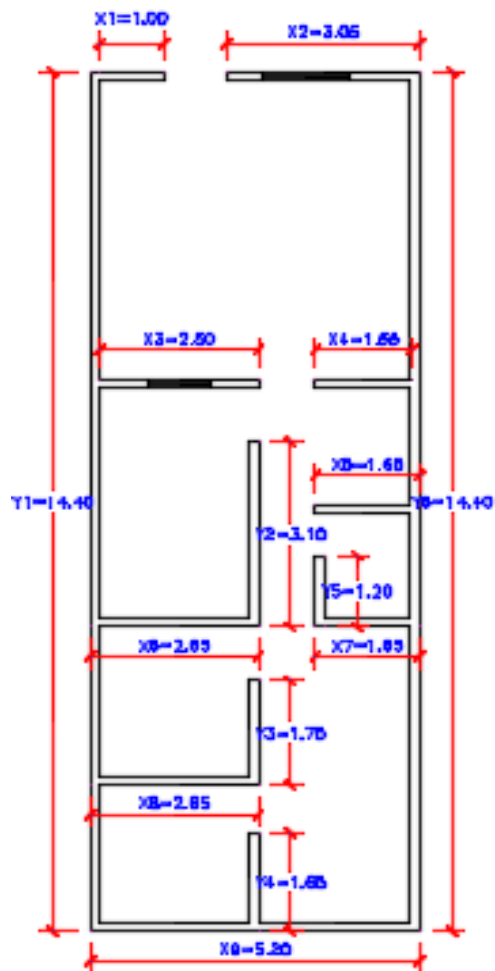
Muros portantes de Vivienda 27, vista de planta.
